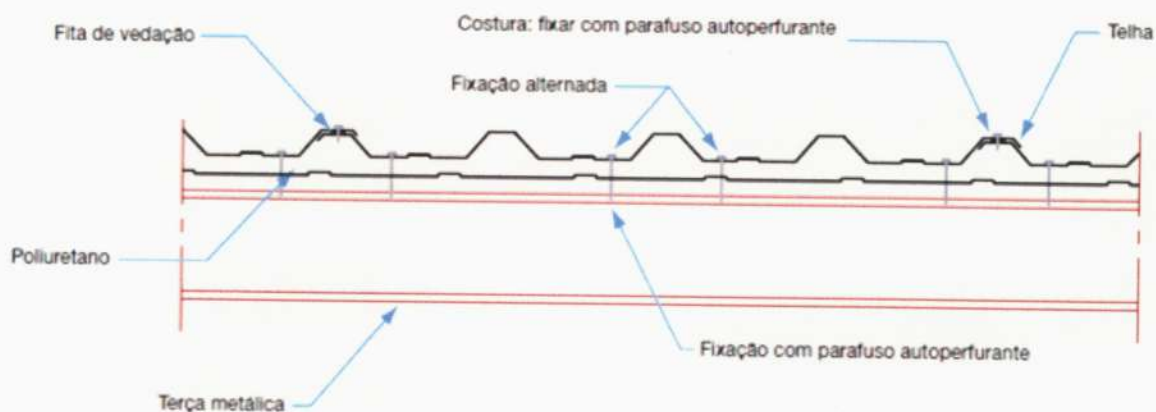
Montagem da telha termoacústica com face plana com PUR (Fonte: ABCEM, 2009)
